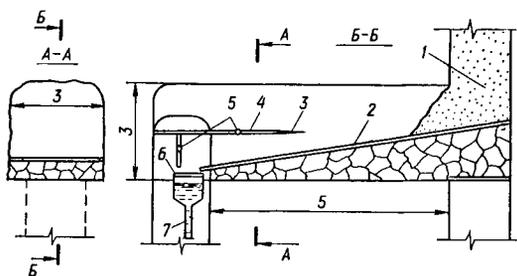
Подземная смесительная площадка для гидрозакладки:
